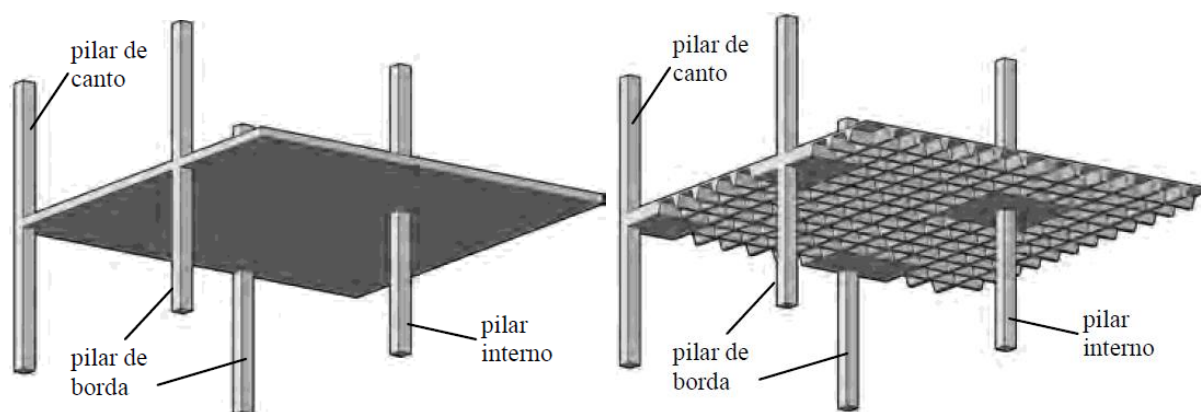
Laje lisa convencional e laje lisa nervurada, respectivamente
